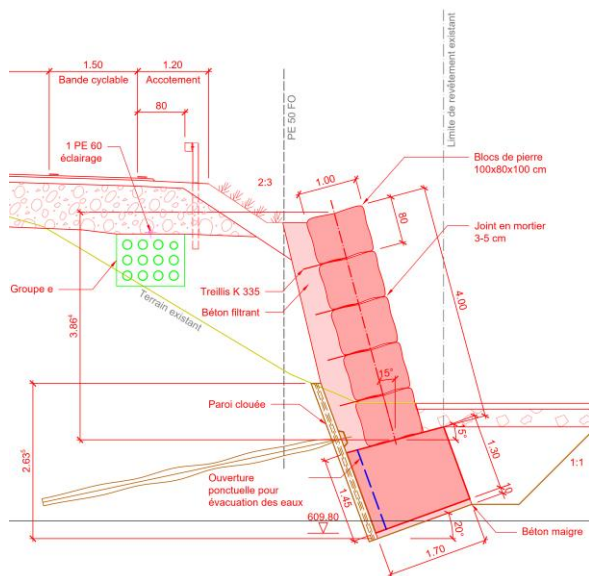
Coupe transversale du Mur de la Gérine (km -0+185)
